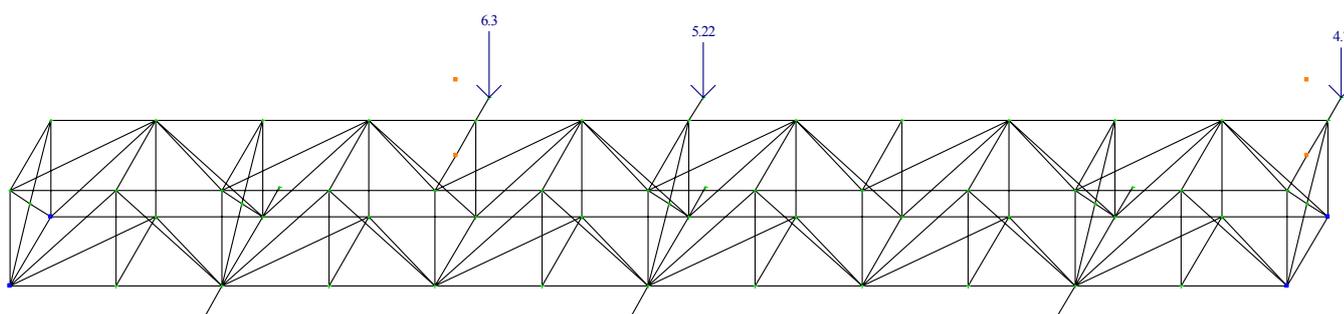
Вертикальные нагрузки от проектируемых трубопроводов
